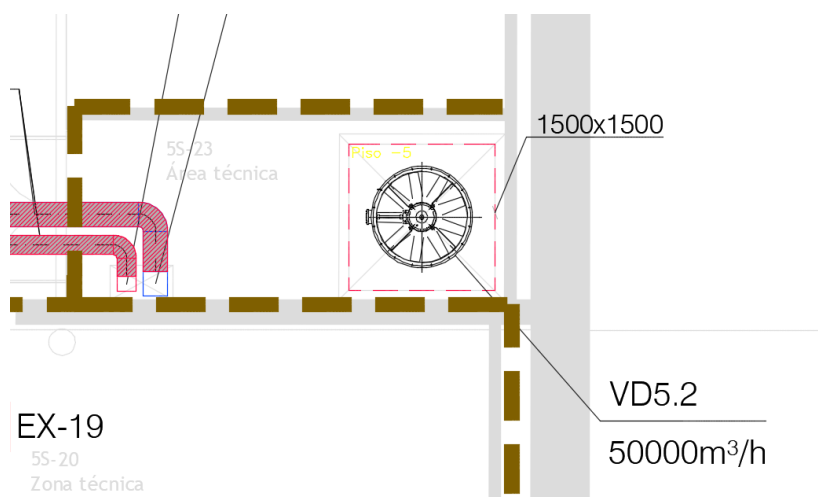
VD-5.2, em planta, no piso -5 – HCD Expansão
